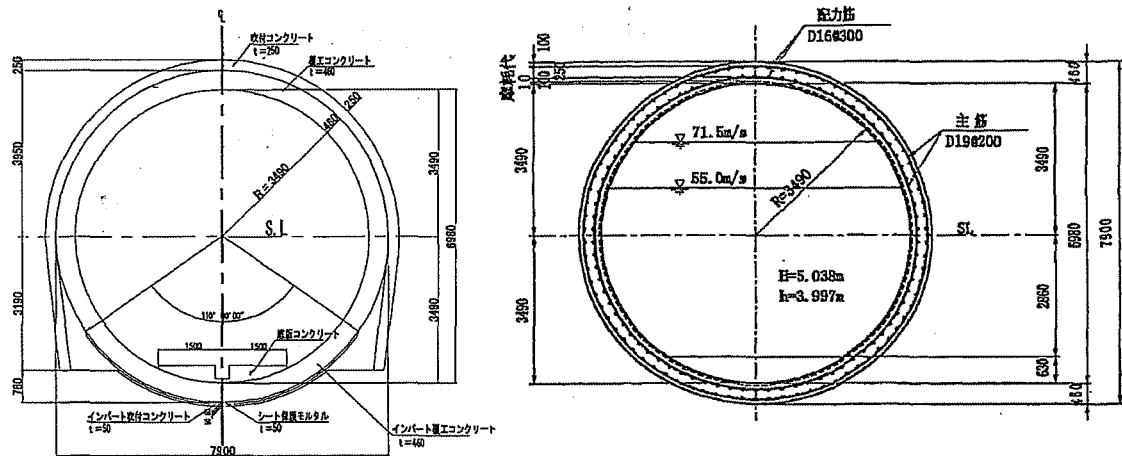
新宇治川放水路標準断面図，覆工標準断面図 (2.19)
